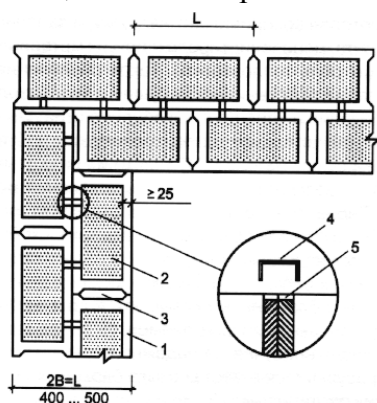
Кладка наружной стены из блоков с термовкладышами:
